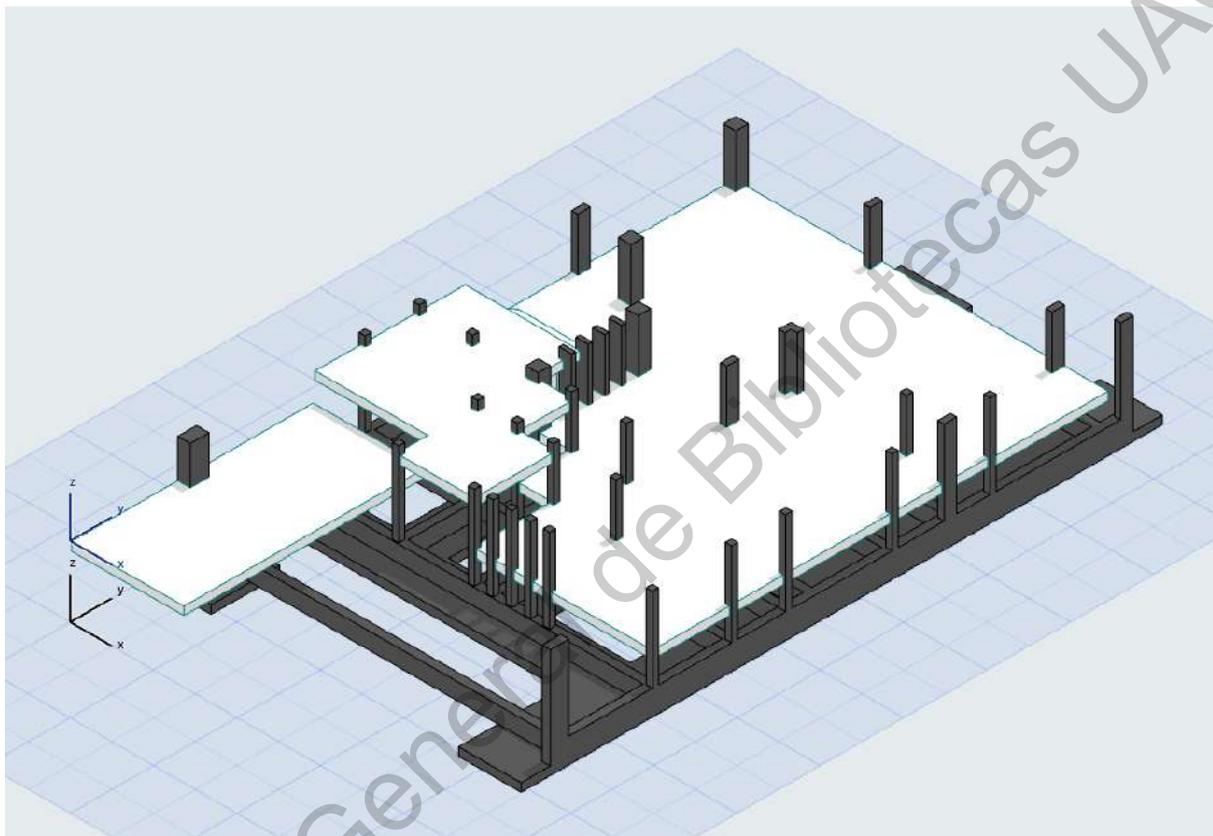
Losa de Concreto de Planta baja de Proyecto 003.
